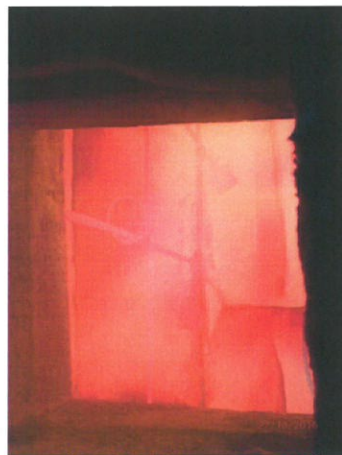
Prüfminute 35: Plattengerissen, schwarzer Riss- und Fugengrund, eingeschränkte Sicht im Brandraum.
